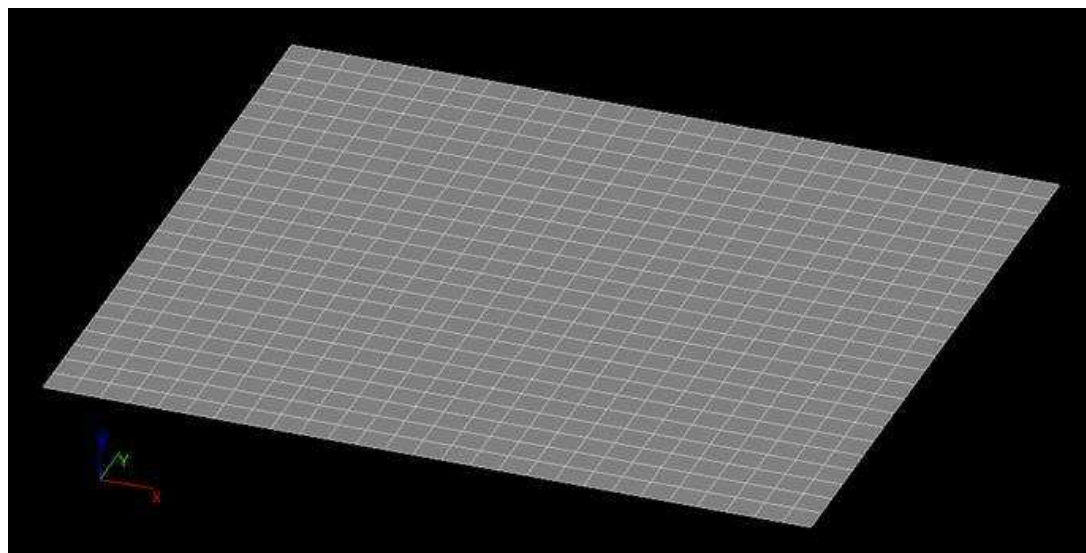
Расчетная схема плиты перекрытия второго этажа
